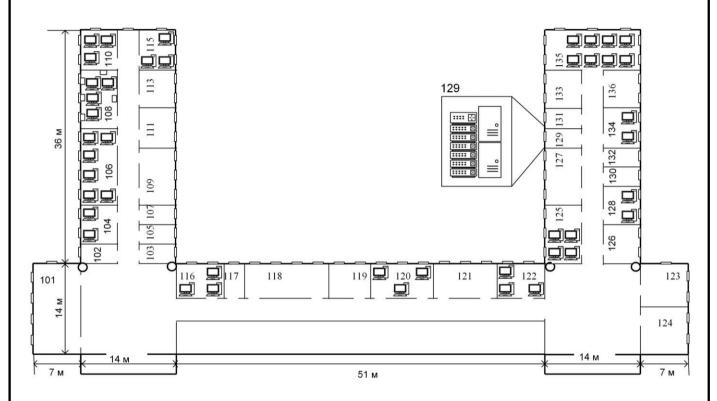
План поверху офісної будівлі з розміщеними на ньому користувацькими машинами
